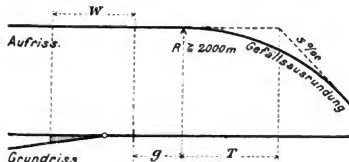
Lage einer Hauptgleisweiche im Gefälle.
